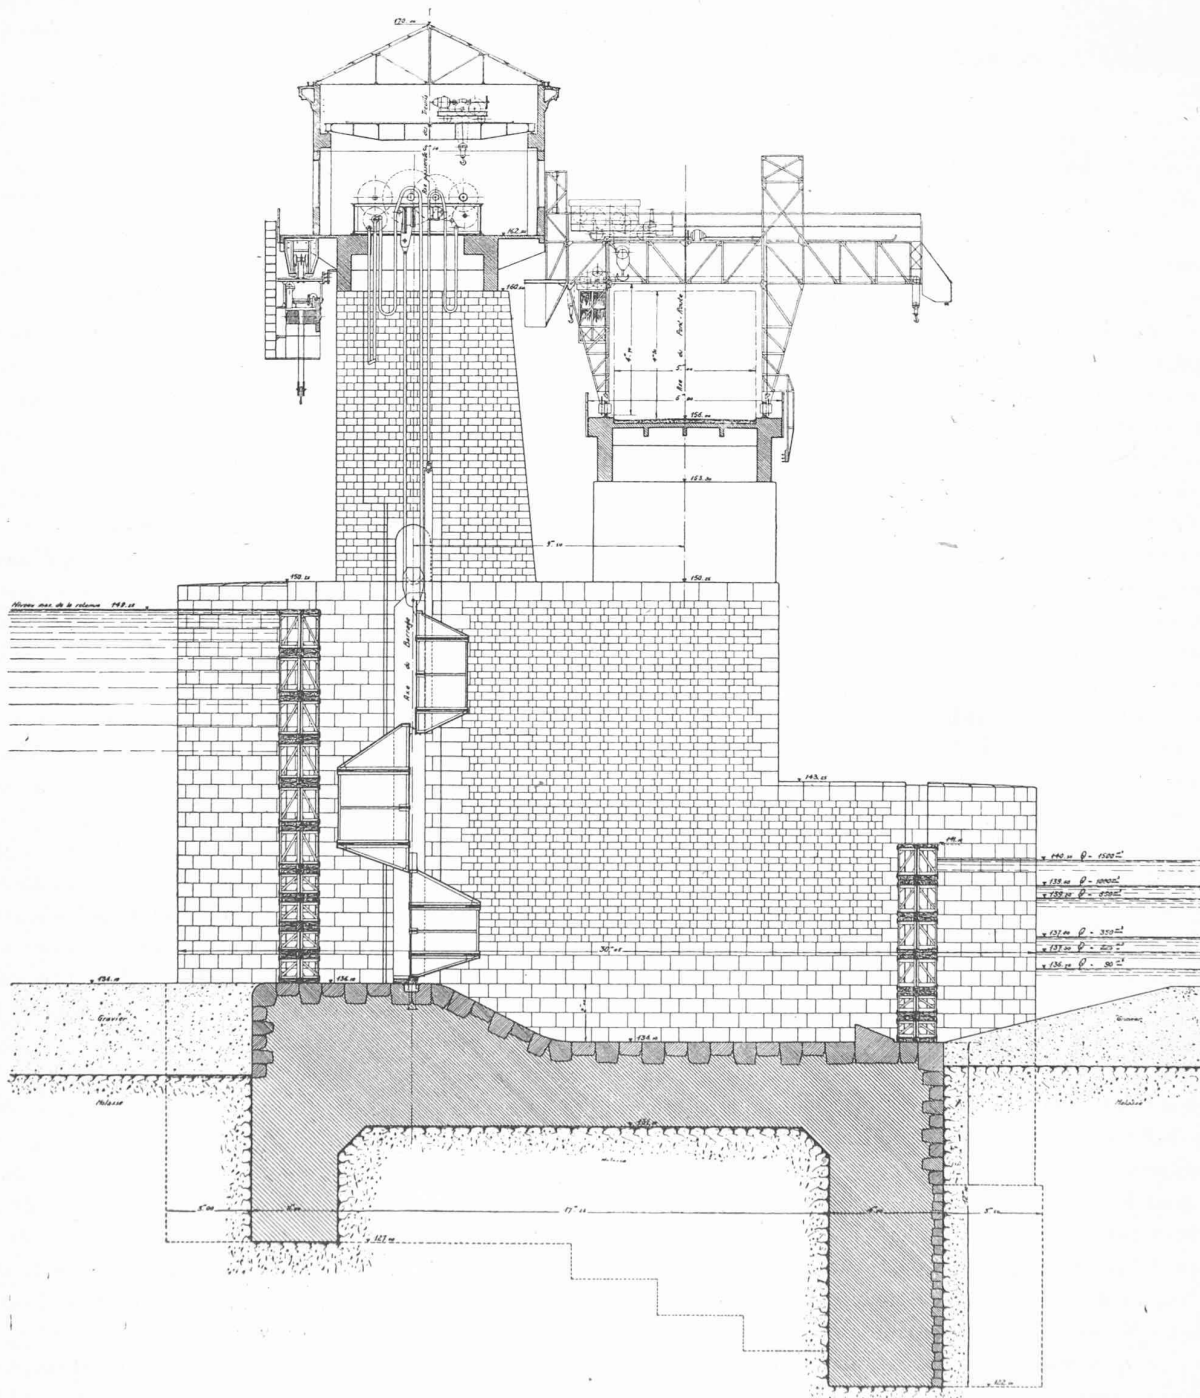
Coupe transversale du barrage de Pizançon suivant l'axe d'une passe. — Echelle 1 : 250.
